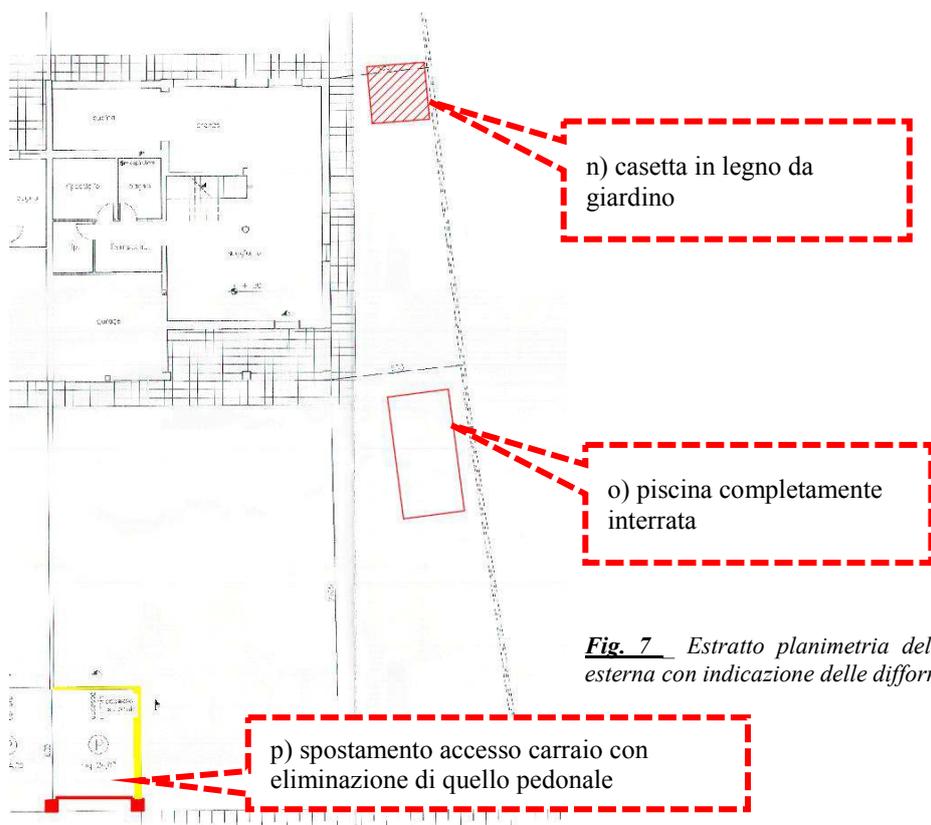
Estratto planimetria dell'area esterna con indicazione delle difformità
